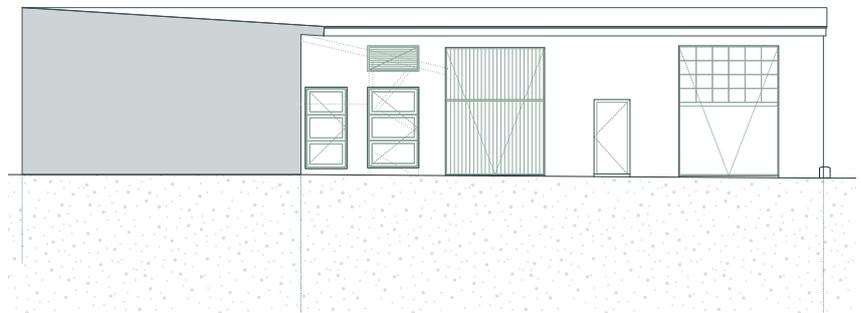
Ansicht Ostfassade Nebengebäude - Garagen, M = 1:200
